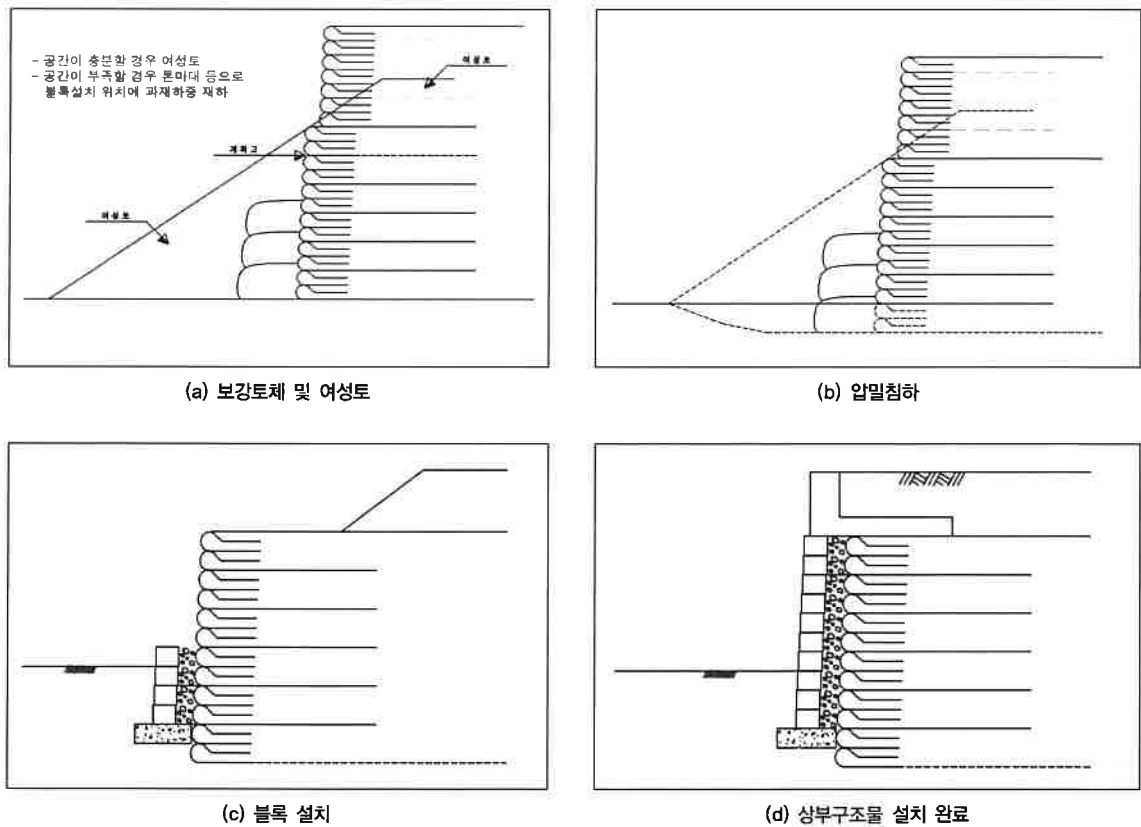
단계시공(Staged Construction)에 의한 보강토 옹벽 시공 개념도
